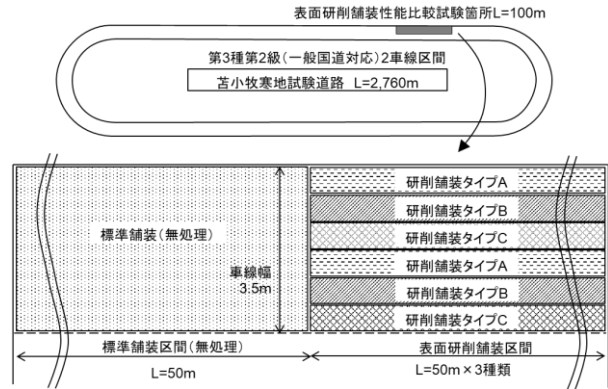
苫小牧寒地試験道路の研削舗装試験箇所平面図
